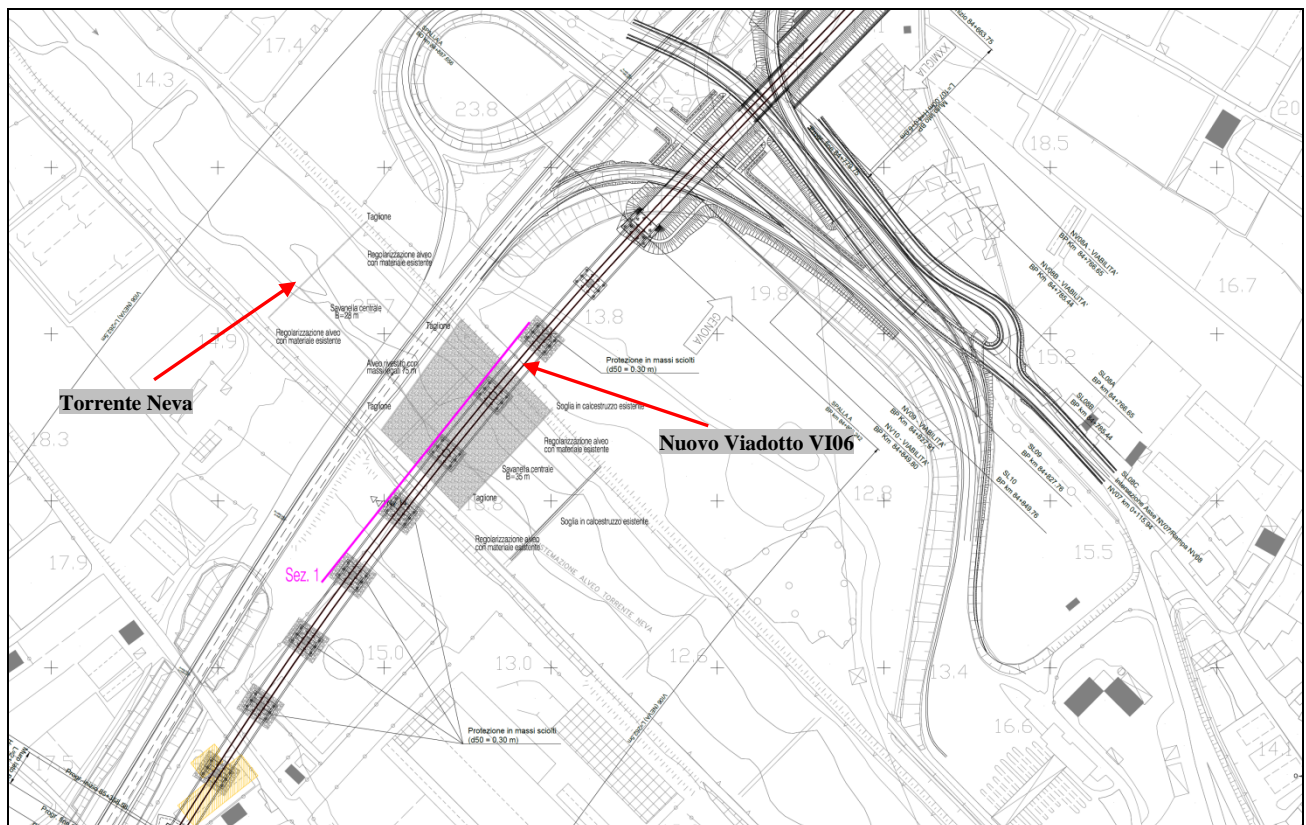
Stralcio della planimetria di progetto in quel di Albenga (attraversamento del Torrente Neva)
